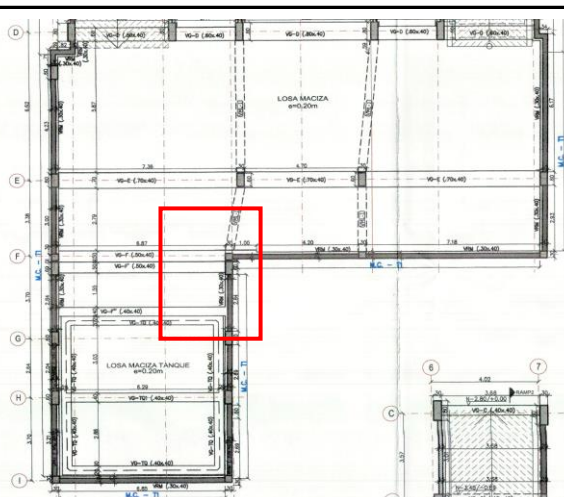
Zona de ubicación tubería RCI Nivel -1,55
